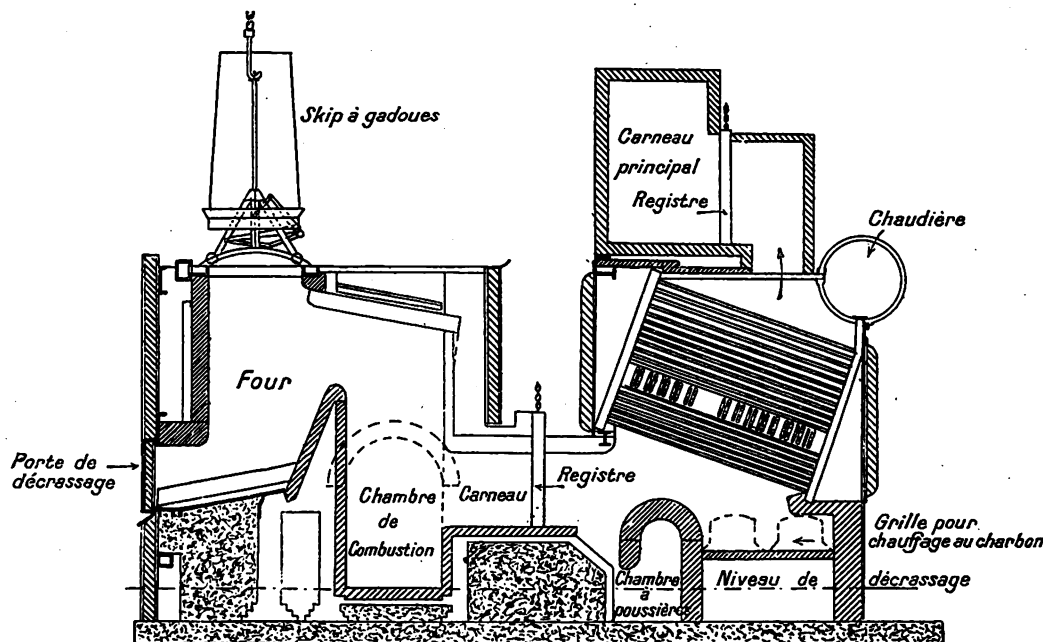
Installation de Greenock, section transversale montrant le destructeur et sa chaudière.
